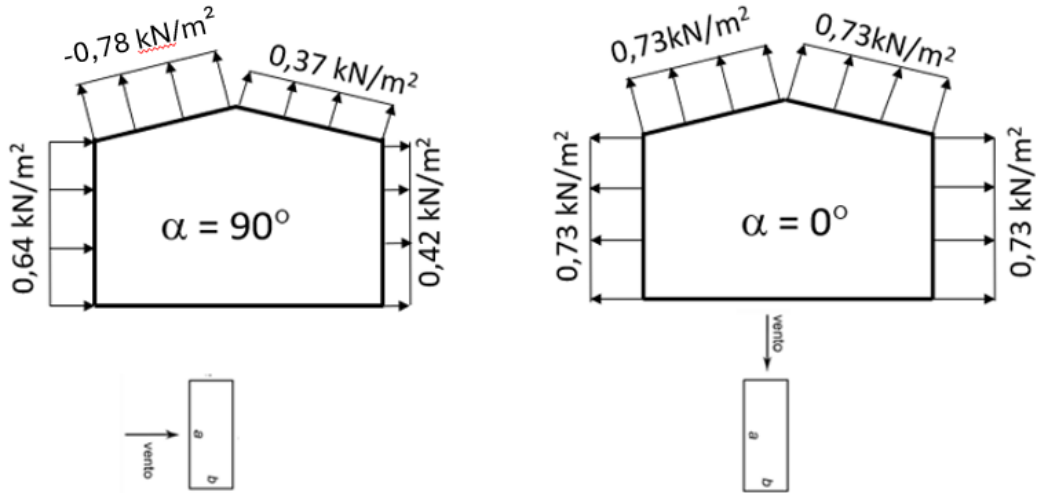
Ação externa transversalmente ao edifício (Ce q fv)
